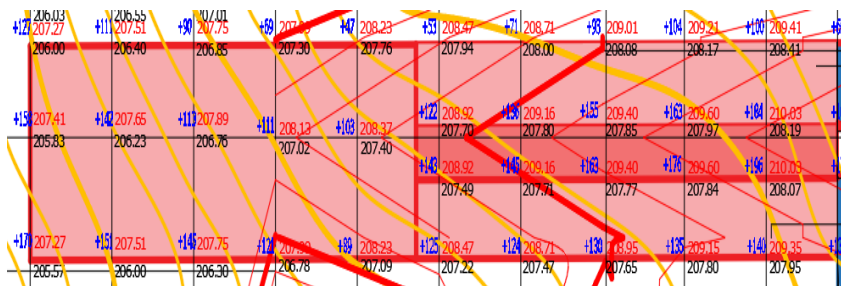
Фрагмент плану вертикального планування ділянки подовження руліжної доріжки швидкісного зльоту
